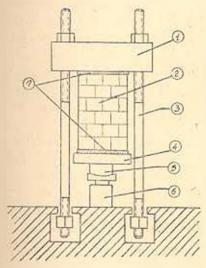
Схема испытания образна кладки на силопом степле. 1—траперс; 2—образен; 3—стоики; 4—опорная плита; 5—сферический парипр; 6—гидрапанческий домкрат; 7—алебастровые подушки.
